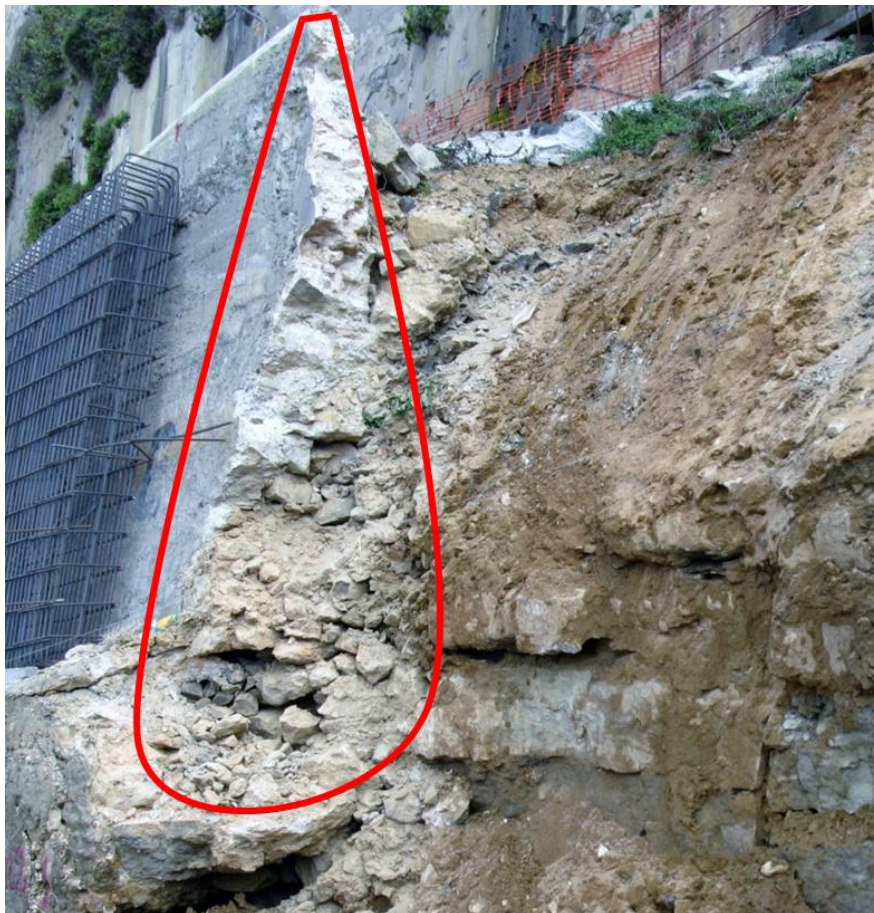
Perfil do muro original com as fundações bastante degradadas, possuindo locais
